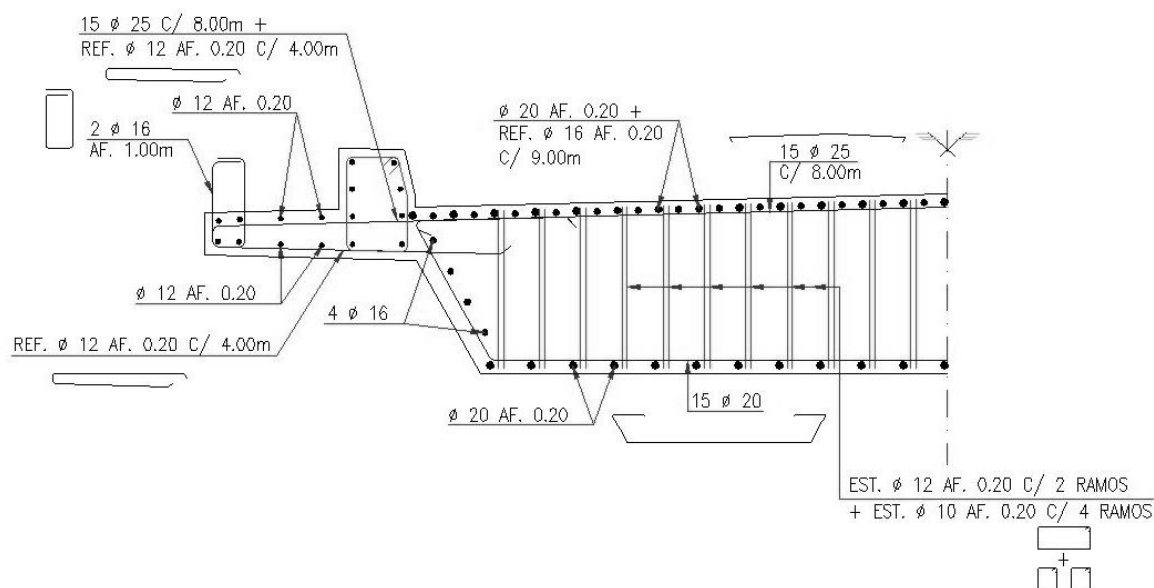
Solução da armadura do tabuleiro, secção sobre o pilar P1 – desenho do projecto.
